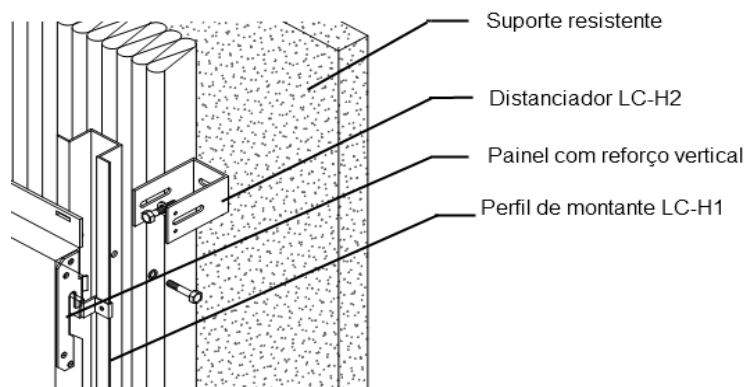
Fixação dos componentes do sistema Larson metals FR. Adaptado de [87].
